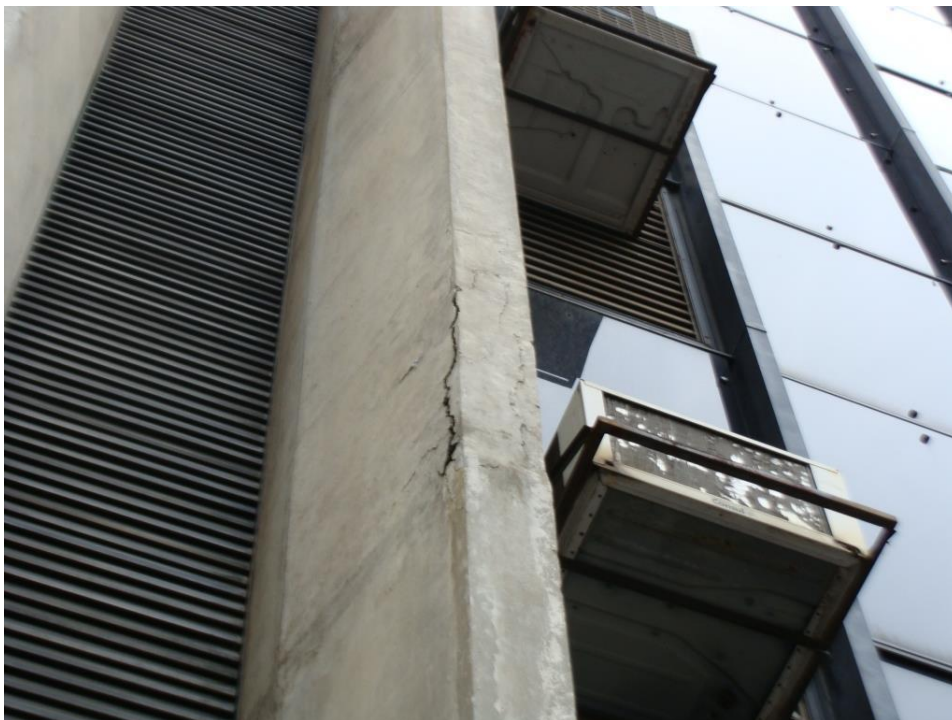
Armadura exposta pilar P12 (1º pavimento) (02/03/2021)
